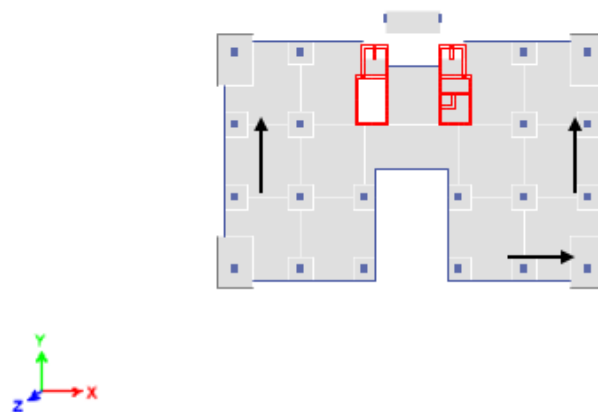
Esquema de ubicación de sensores en la Cuarta planta de la estructura. Instrumentación Tipo 1.
